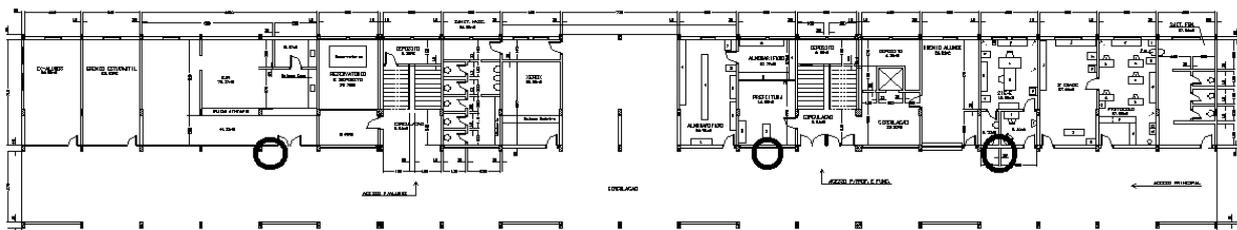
Localização recomendada para as tomadas de incêndio do pavimento térreo.
